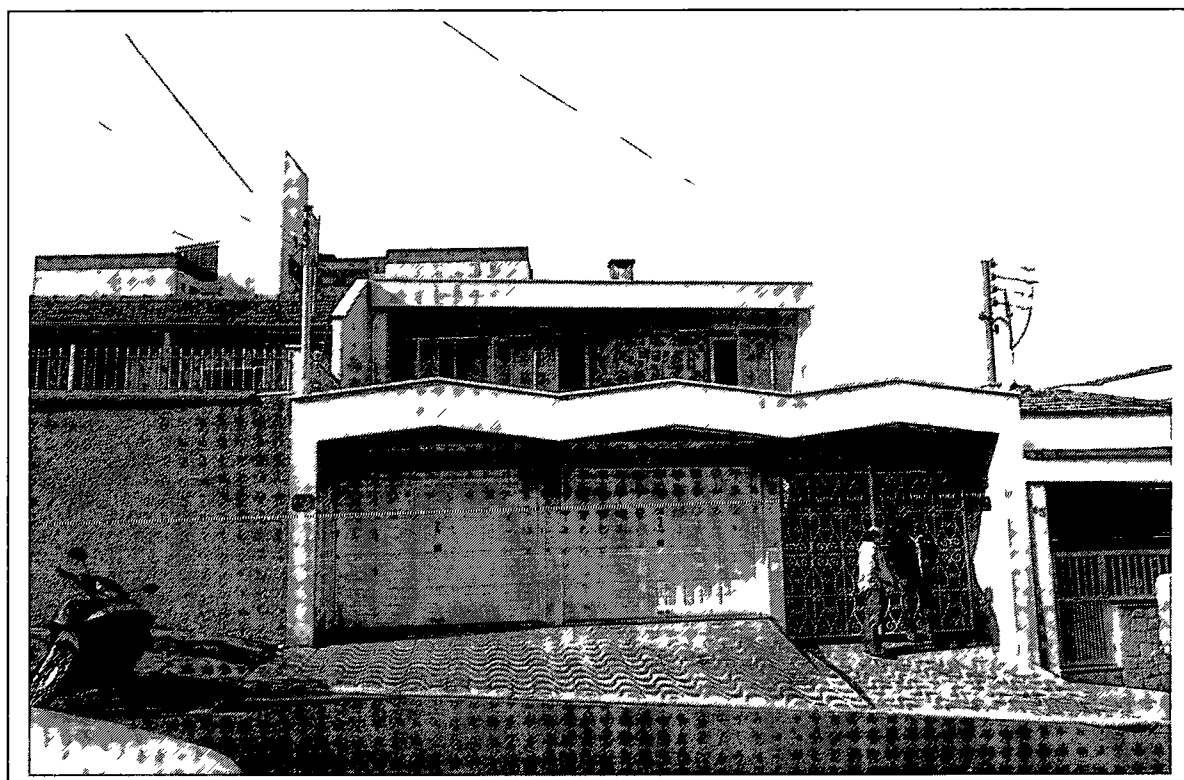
Vista da fachada do imóvel sob nº 35 da Rua Santa Madalena
